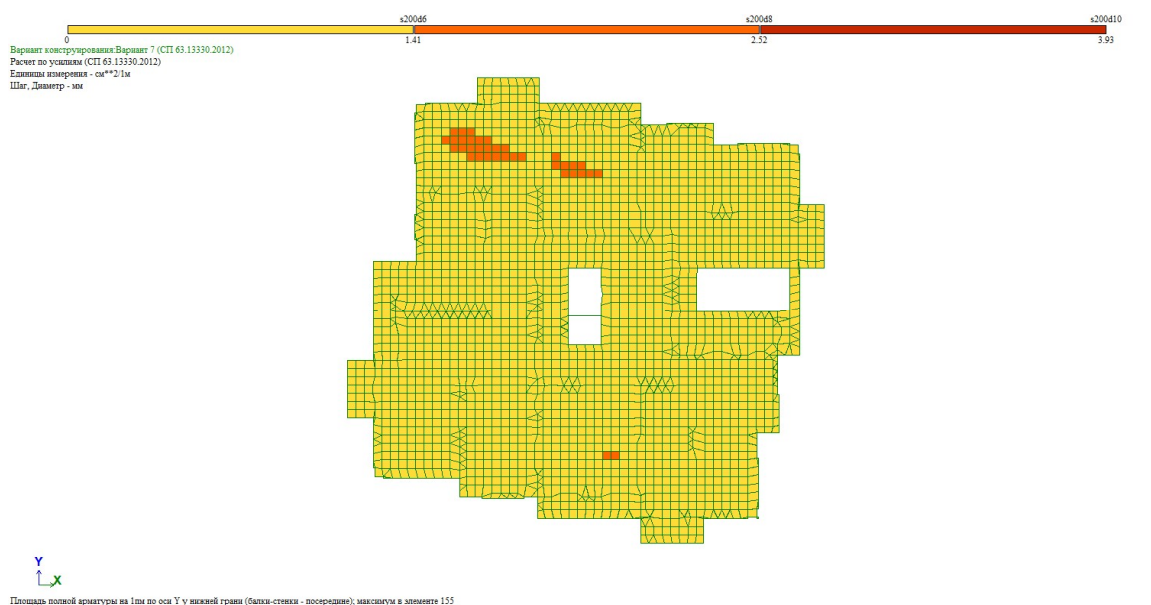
Нижнее армирование перекрытия этажа по оси Y
